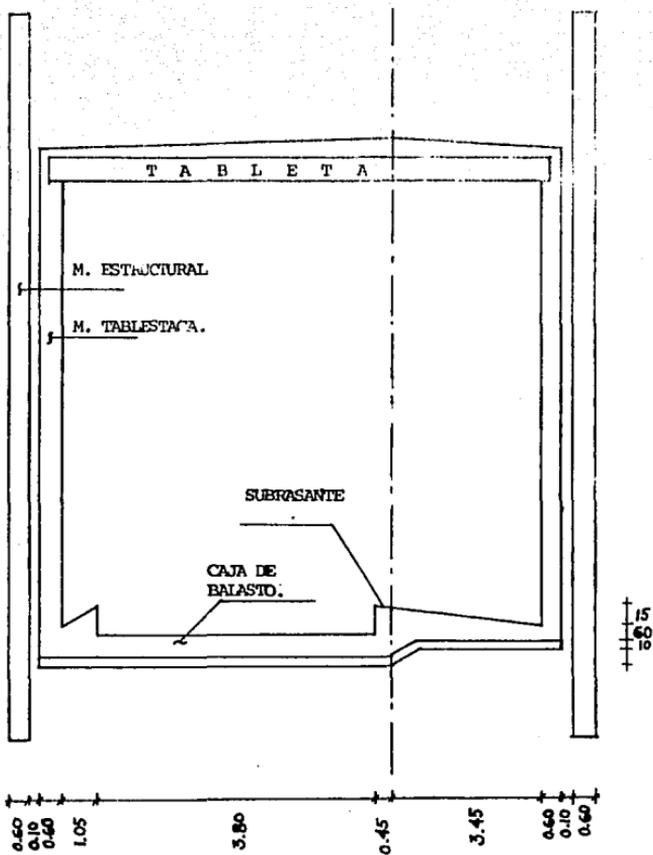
LOSA INFERIOR CON CAJA DE BALASTO..
